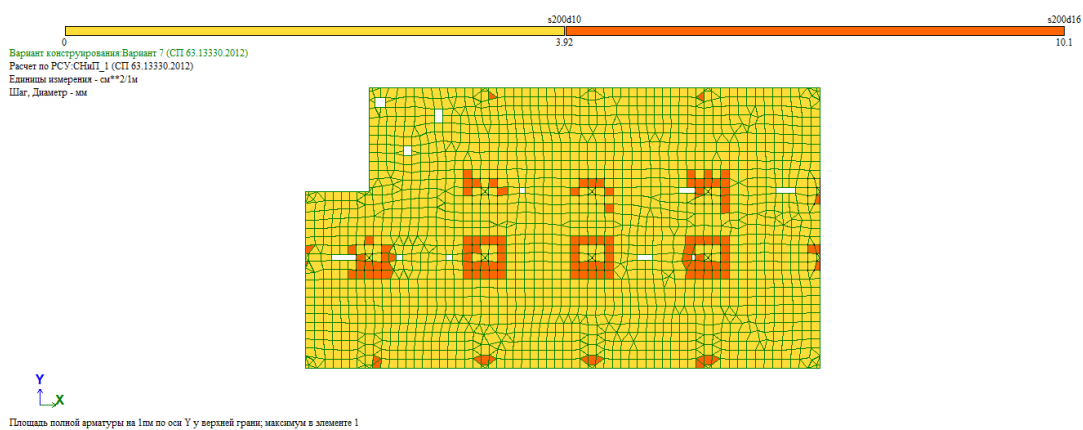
Армирование верхней зоны монолитной плиты по оси Y
